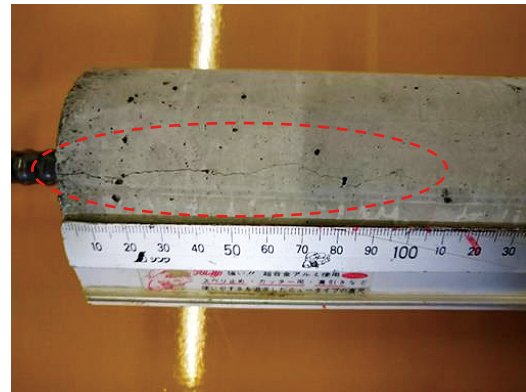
70N/mm<sup>2</sup>試験体のひび割れ状況
